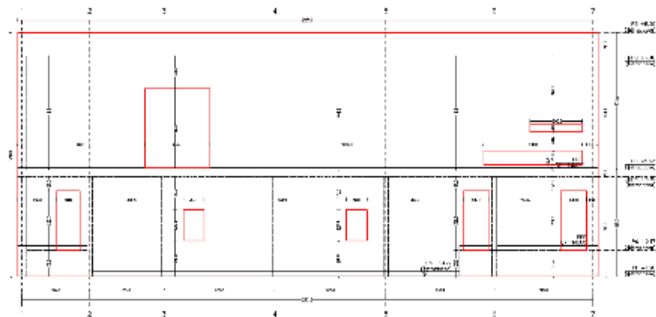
Pianta piano terra scuola: VMC in progetto
